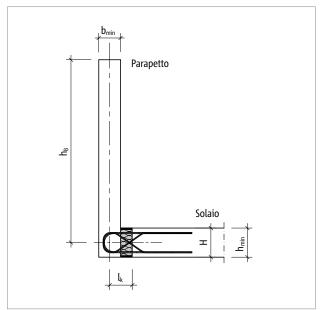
Schöck Isokorb® T tipo AP: sistema statico con altezza del parapetto h_B ; altezza H Isokorb®
